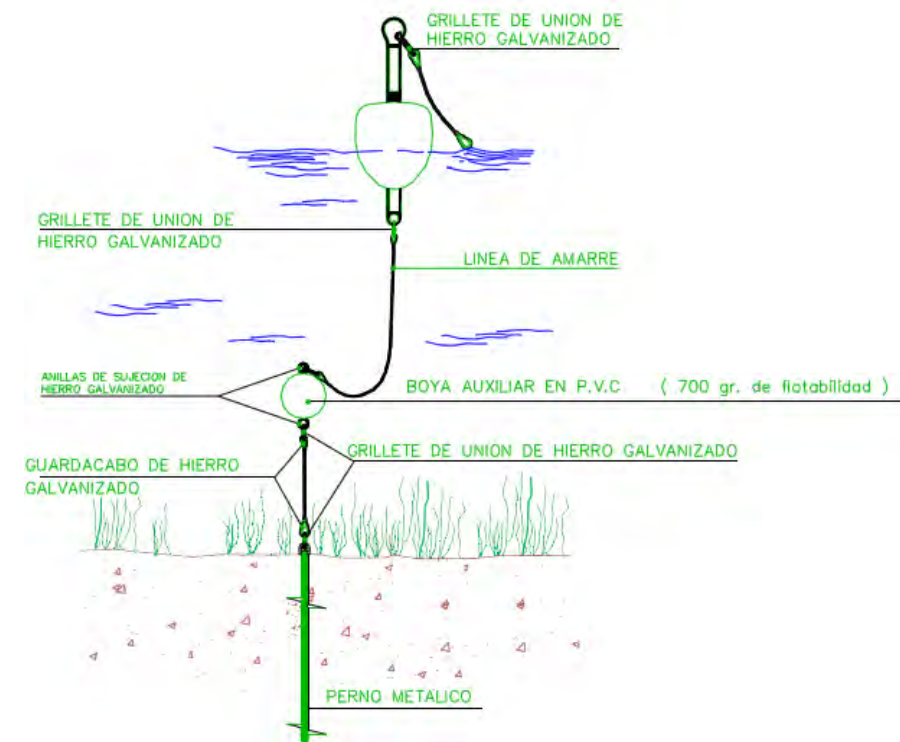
Esquema de las amarras y tren de fondeo adoptado para los fondeos de bajo impacto.
